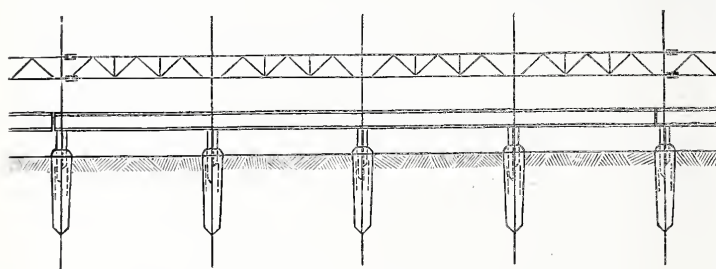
Gleisanlage 1904. Grundriß und Ansicht.
